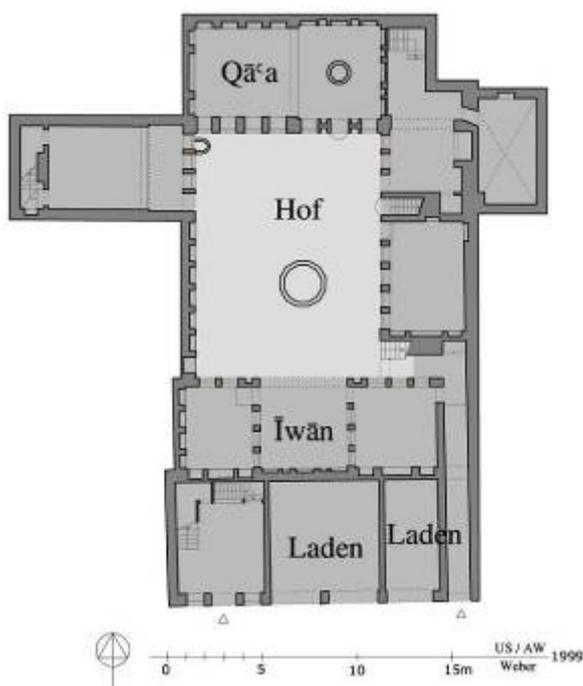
Bayt Zanānīrī, Grundriss EG
